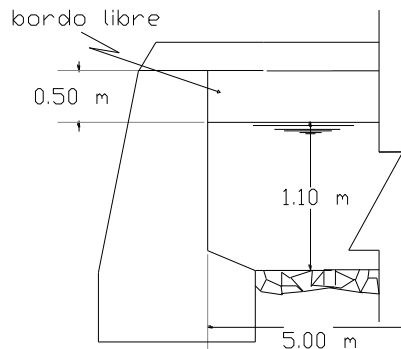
Área de la sección de la alcantarilla 2.
